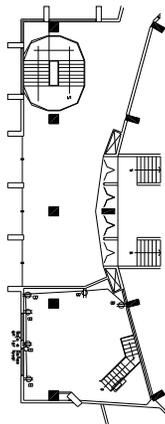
Plano de instalación eléctrica de fuerza en nivel 1
